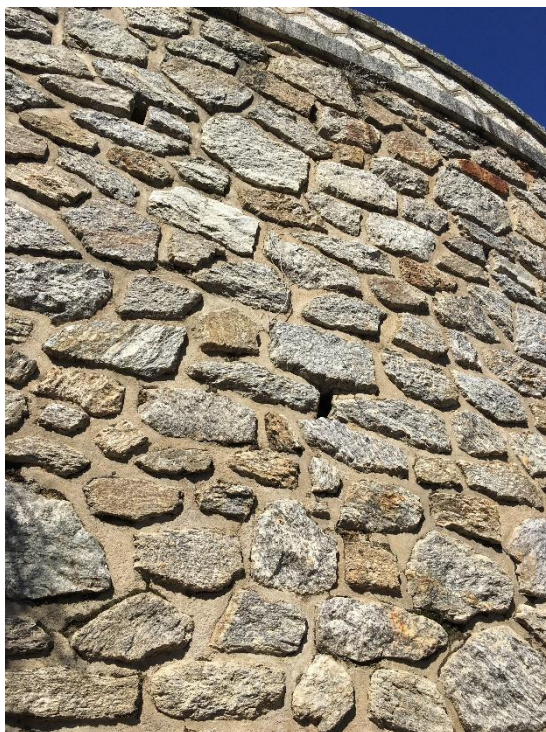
Fotografía del paramento del muro en zona de la grieta 3.
